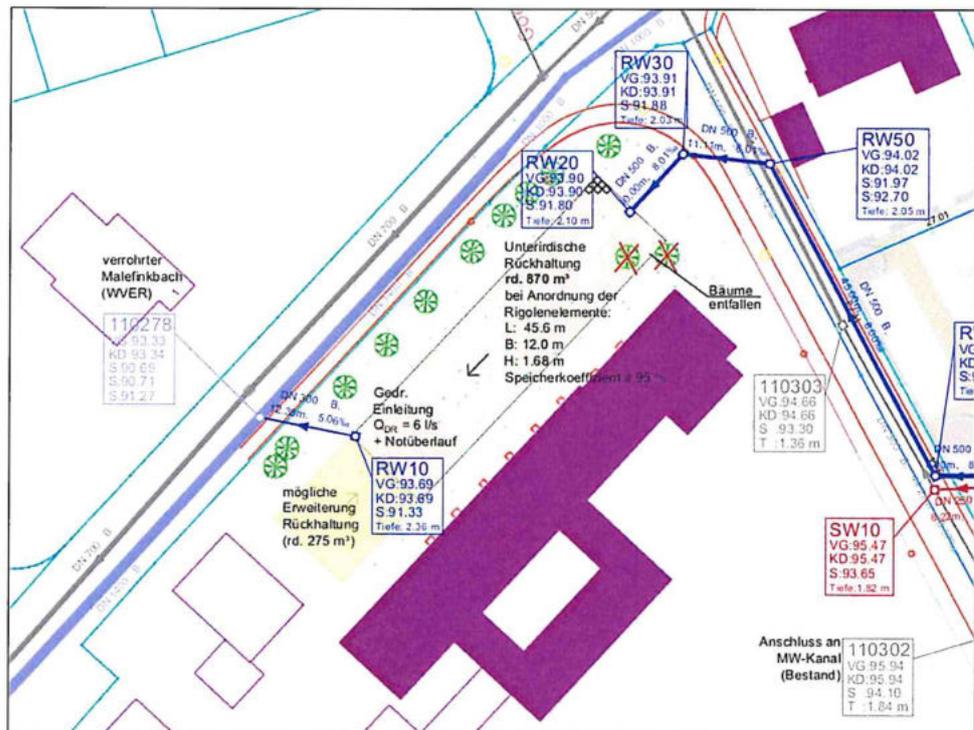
Lageplanausschnitt unterirdische Rückhaltung in Wiesenfläche
